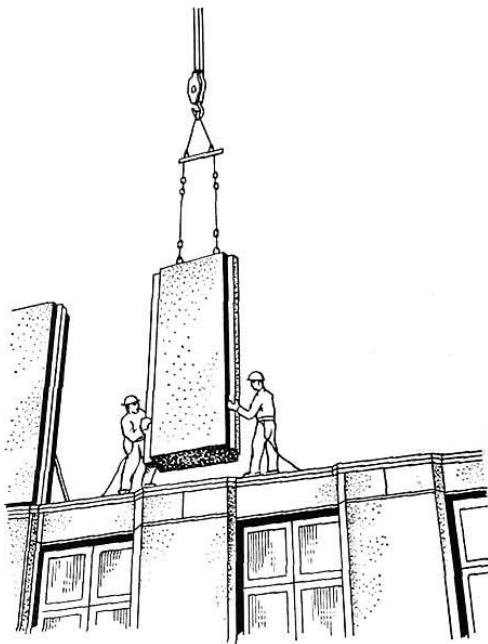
Монтаж простеночного блока крупноблочного здания с двухрядной разрезкой стен
